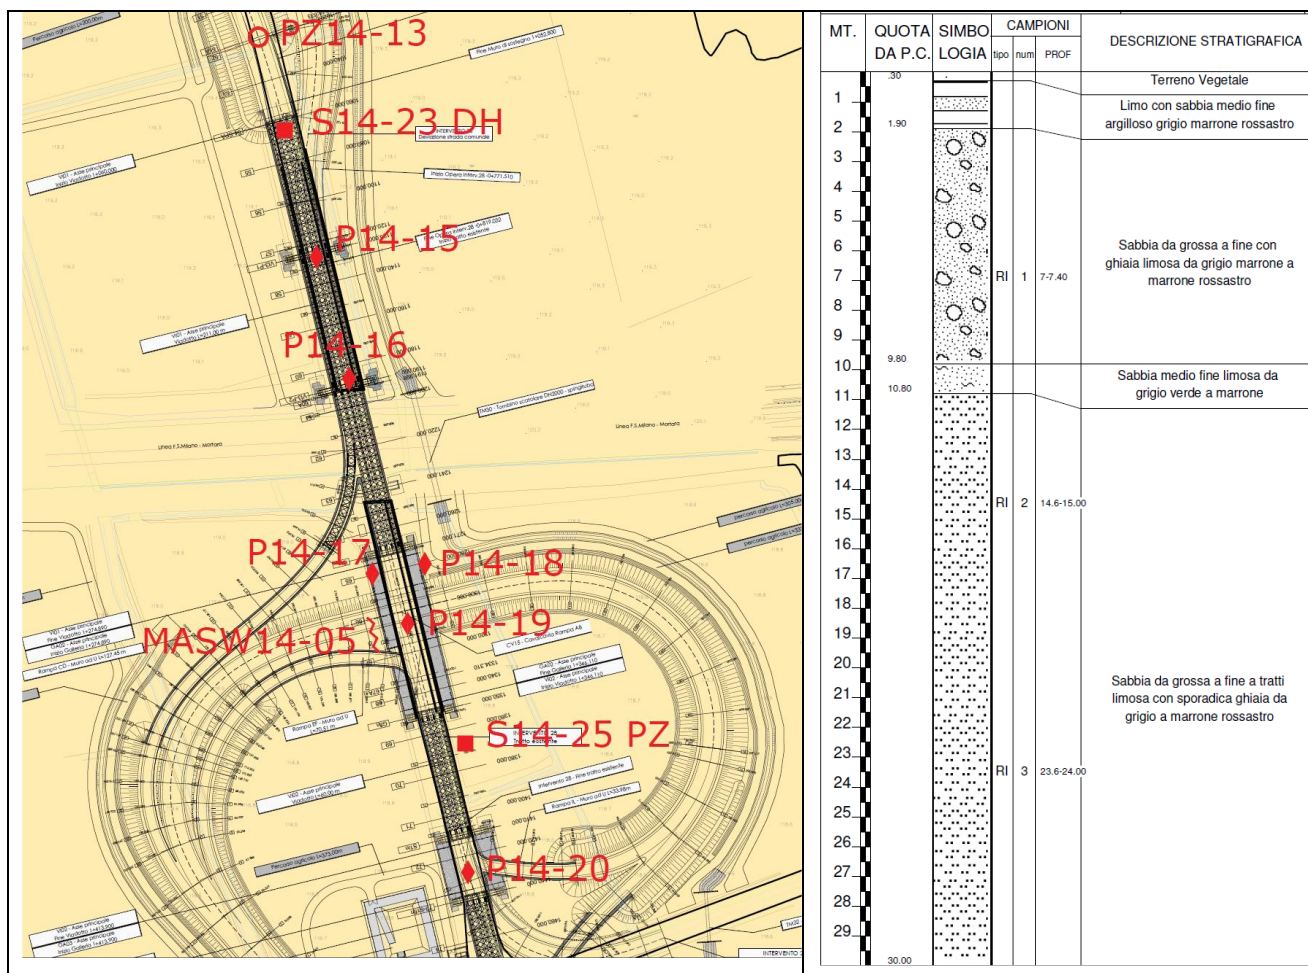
Stralcio planimetrico e sondaggio S14-23 di riferimento
